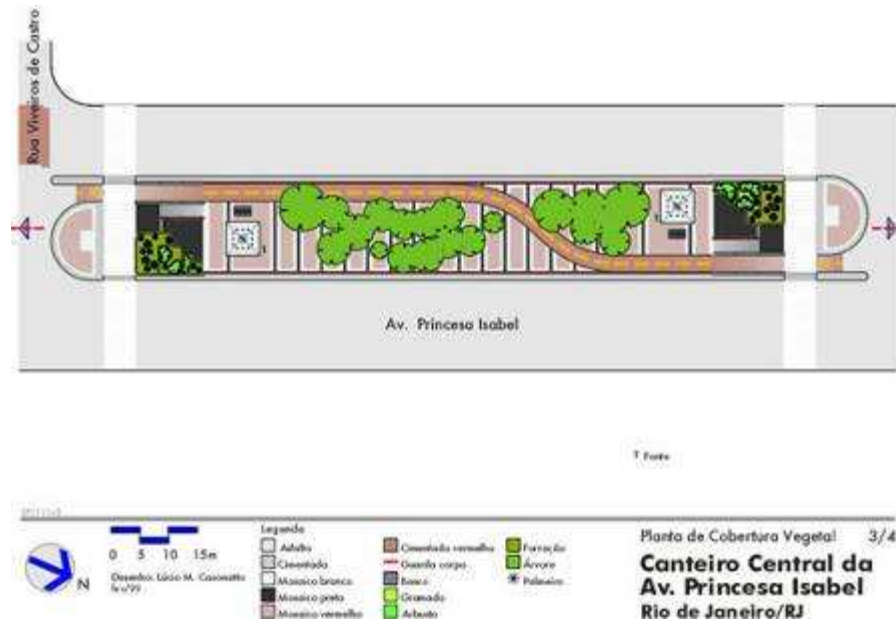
Planta de cobertura vegetal de parte do canteiro central da Avenida (QUAPÁ, 2010).
